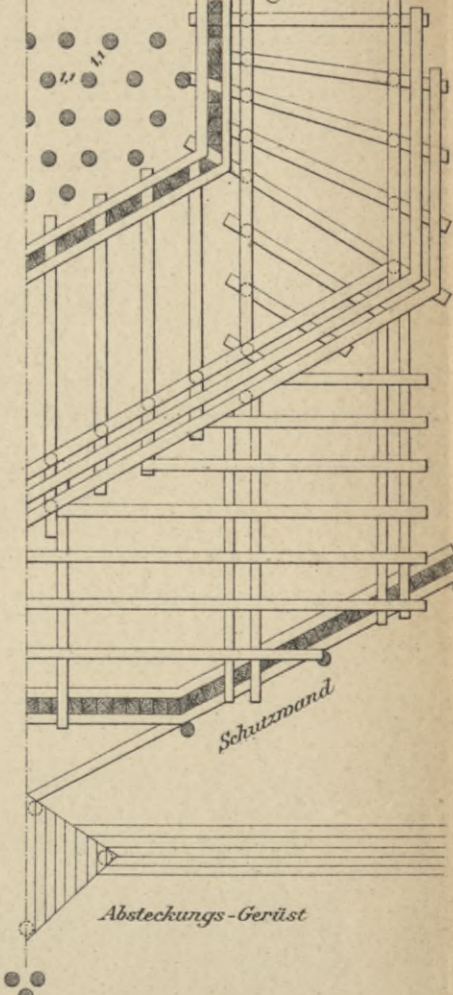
Grundriss. A plan view diagram of the bridge pier for the Elbe Bridge at Harburg.
